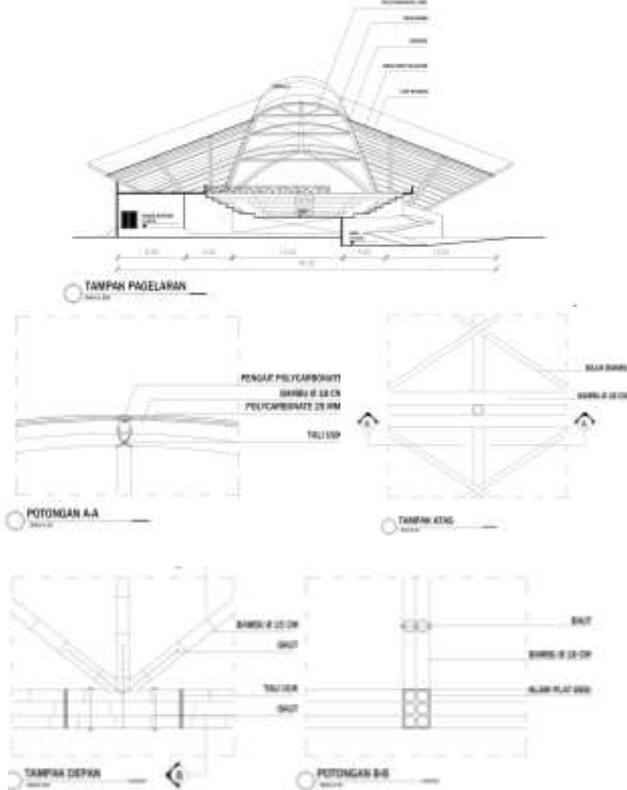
Sambungan bambu membentuk susunan kolom struktur kayu
